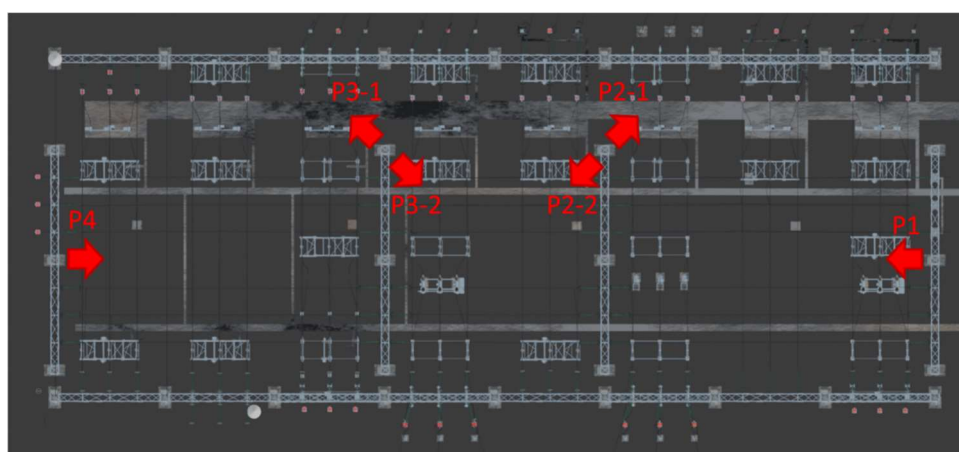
Câmeras previstas para instalação, planejadas usando a ferramenta proposta
